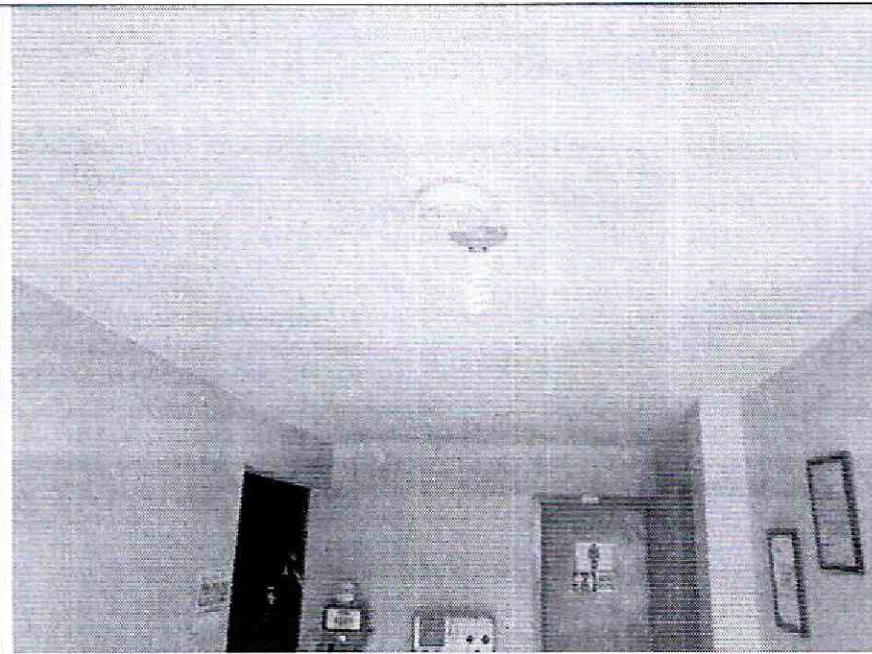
Cielo raso bajo cubierta sin evidencias de daño.
